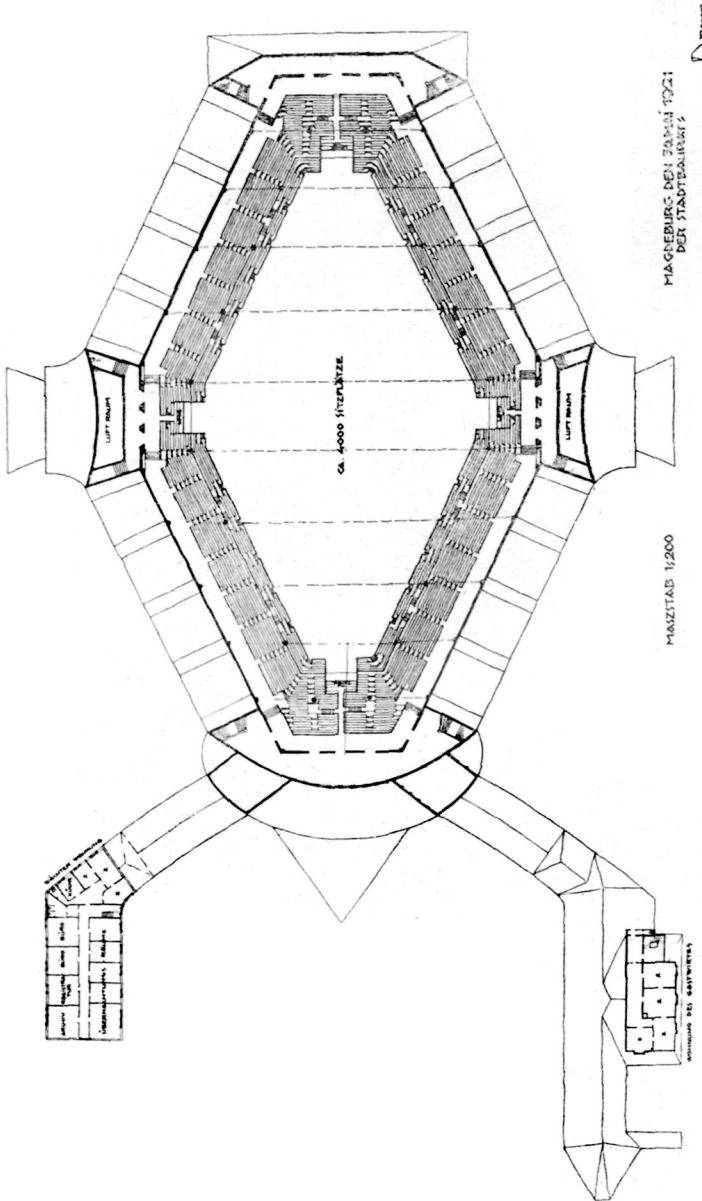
Halle Stadt und Land Magdeburg. Emporegeschoß-Grundriß
